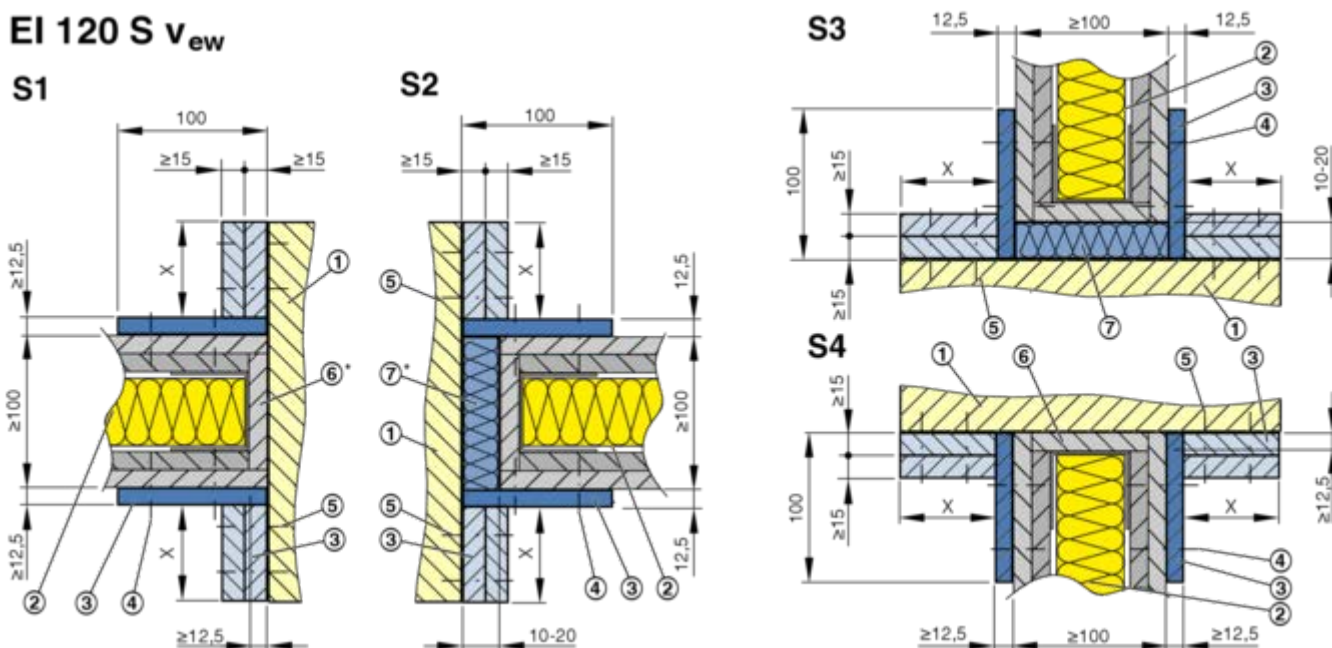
Dettagli installazione a secco senza malta EK-JZ in una parete piena, parete piena con intercapedine EI 120 S, legenda ↪ Fig. 38
